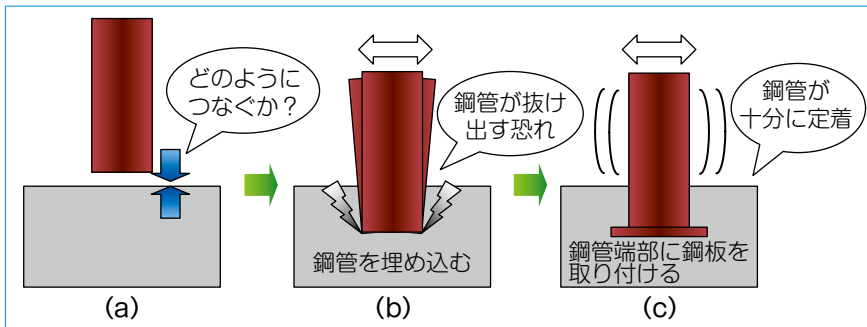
コンクリート充填鋼管部材と鉄筋コンクリート部材のつなぎ方の例
